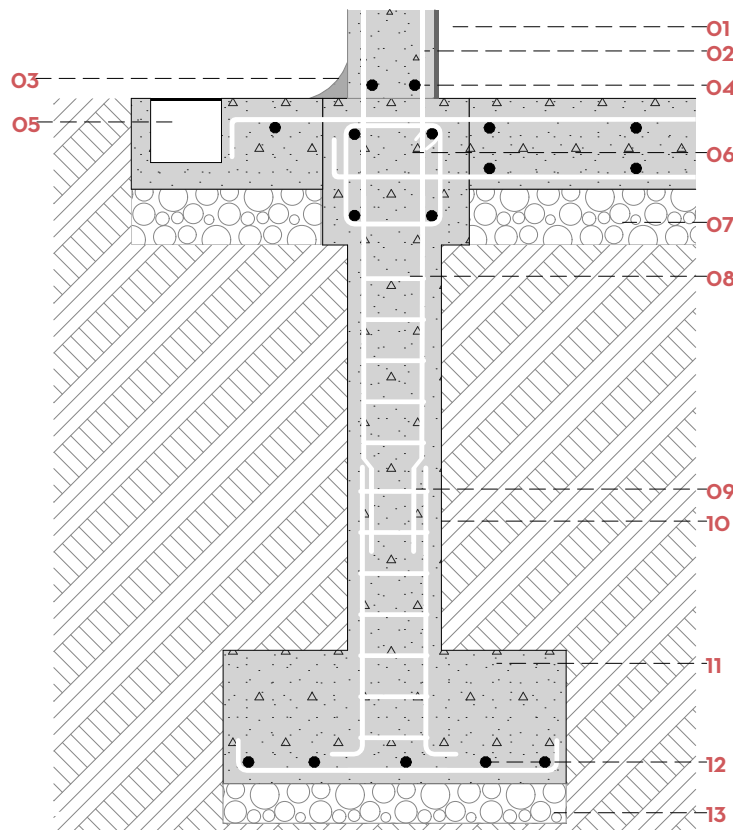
Detalle constructivo O2. Fuente: Autoría propia.
